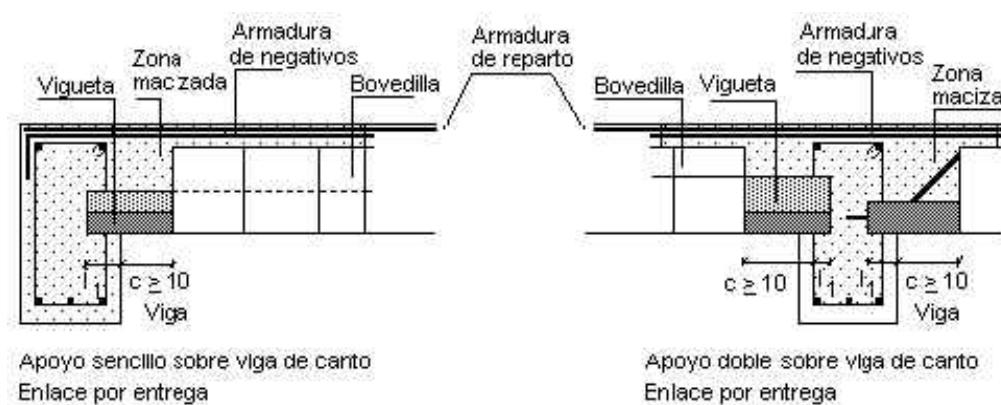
Detalle ilustrativo de la unión entre las vigas-viguetas.
